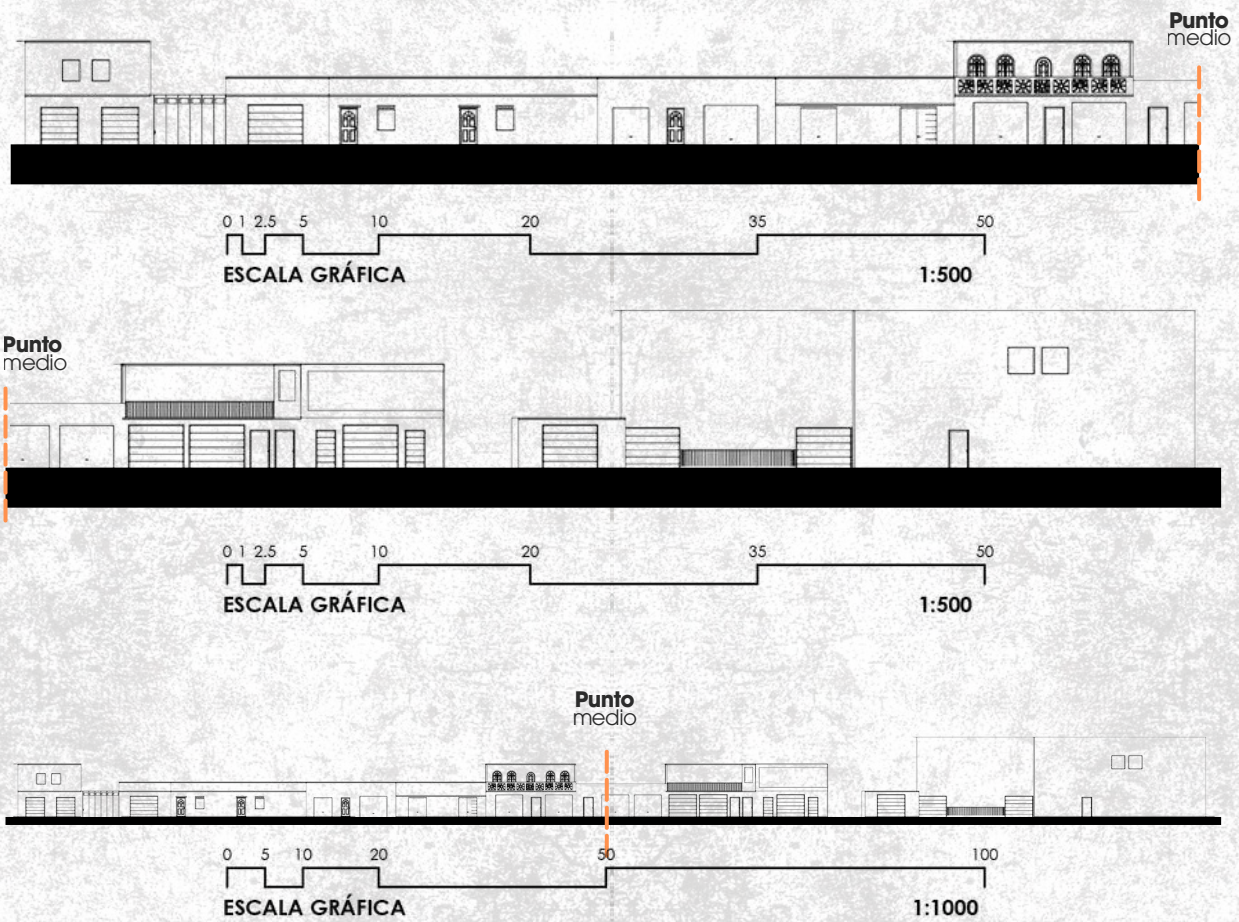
Ubicación y levantamiento técnico de fachada 4 Oeste tramo 2
